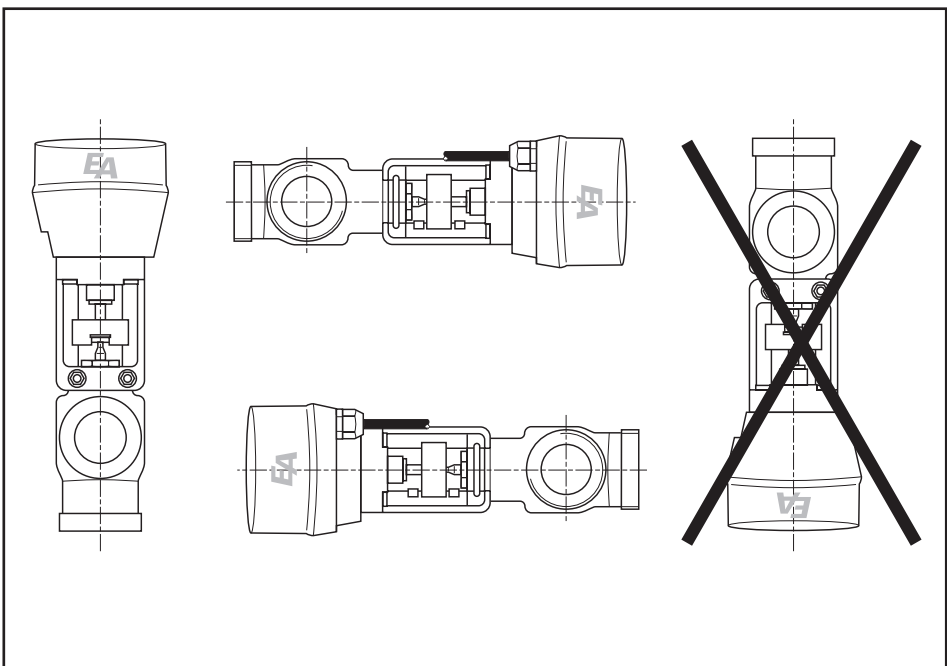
Beschreibung der Antriebe: Einbaulage Antrieb 21/23
